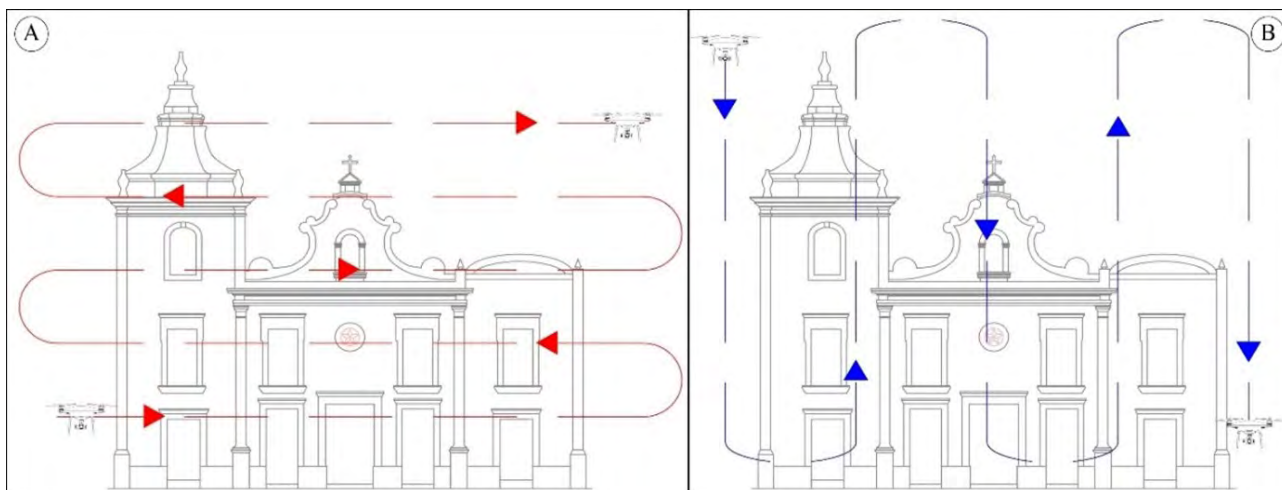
Detalhes do levantamento da fachada; A. voo na horizontal; B. voo na vertical.
